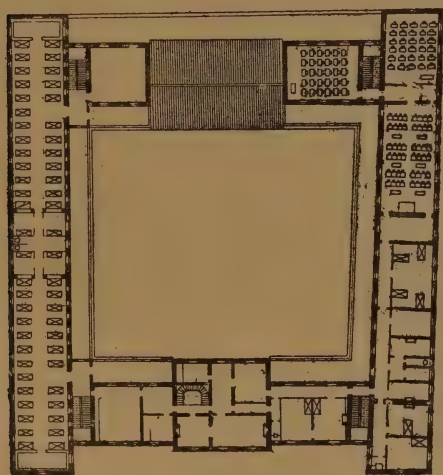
Collège de Tlemcen, plan du premier étage.
